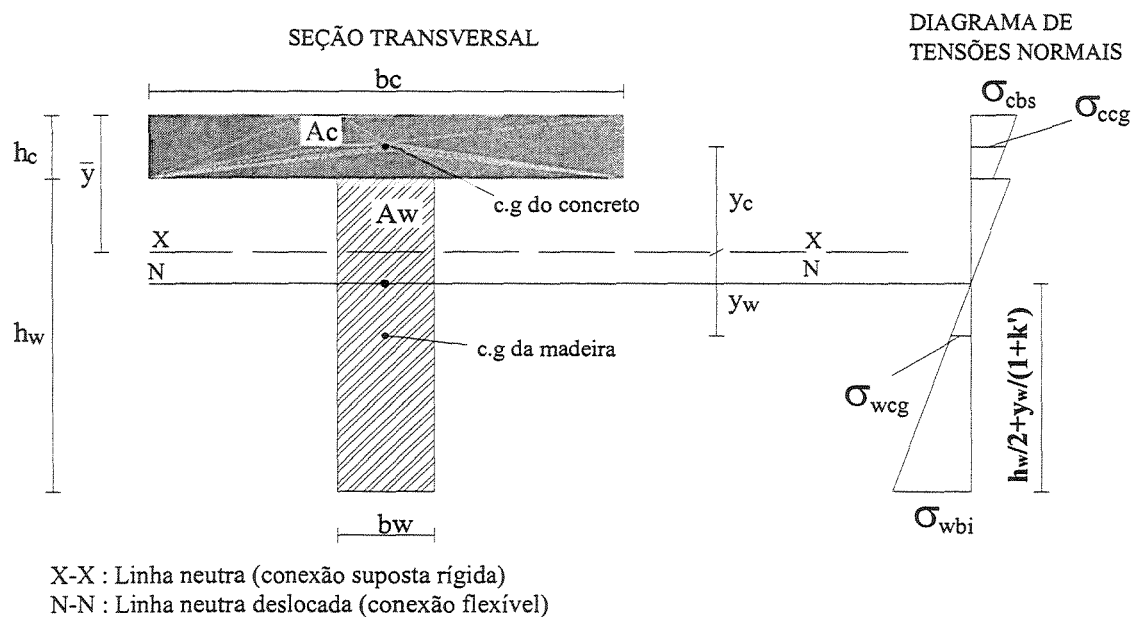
Seção transversal de uma viga "T" e tensões normais
